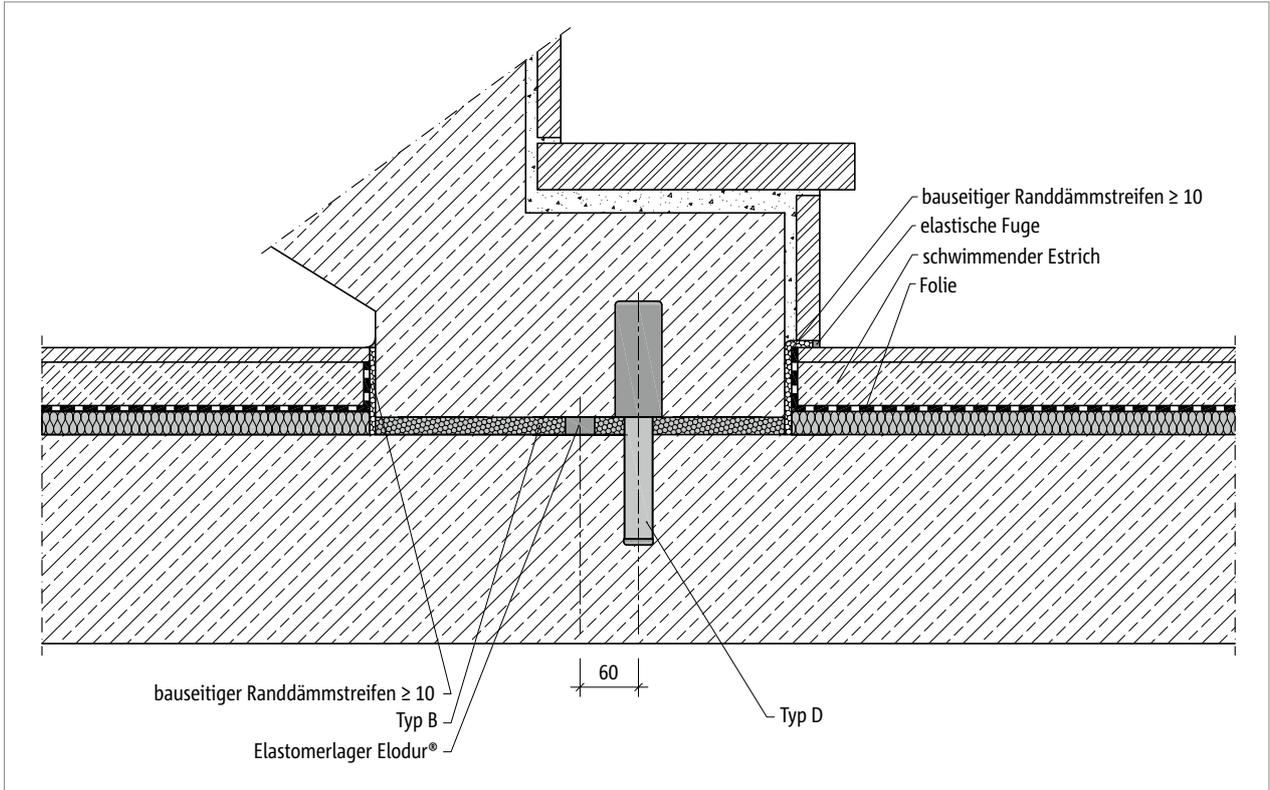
Schöck Tronsole® Typ B + Typ D: Einbauschnitt
